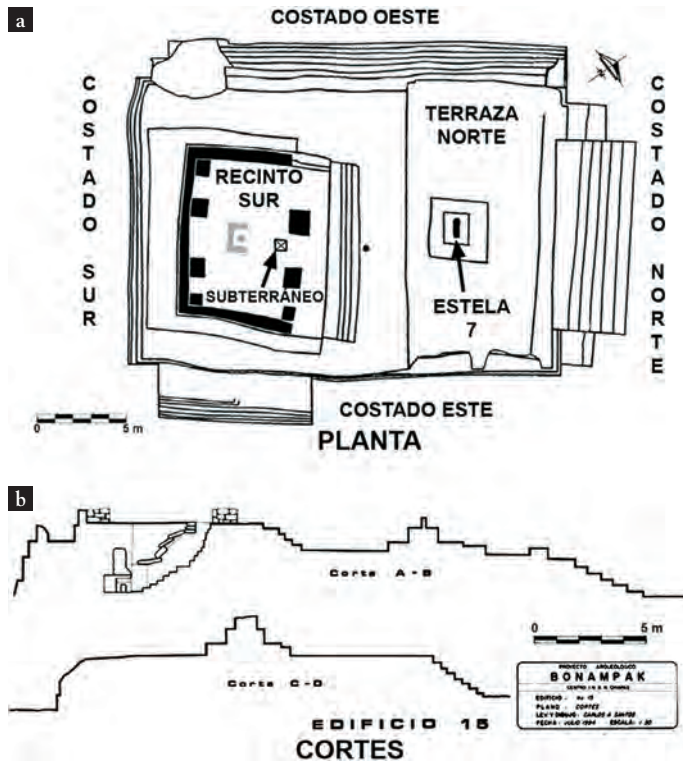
Edificio 15. a) Planta arquitectónica del edificio 15. b) Cortes arquitectónicos del Edificio 15.
